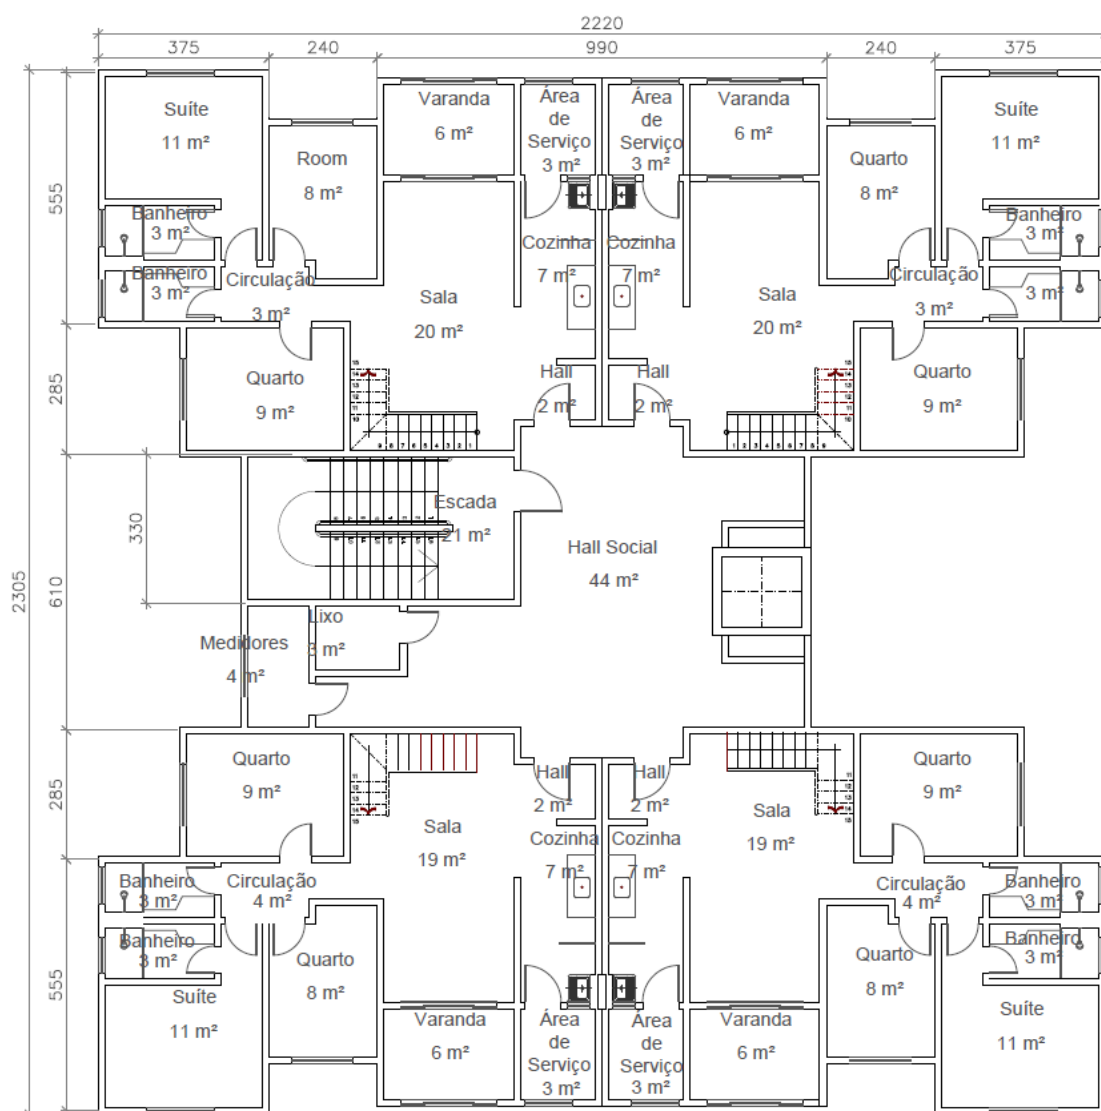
Projeto arquitetônico do primeiro pavimento do apartamento de cobertura da edificação
